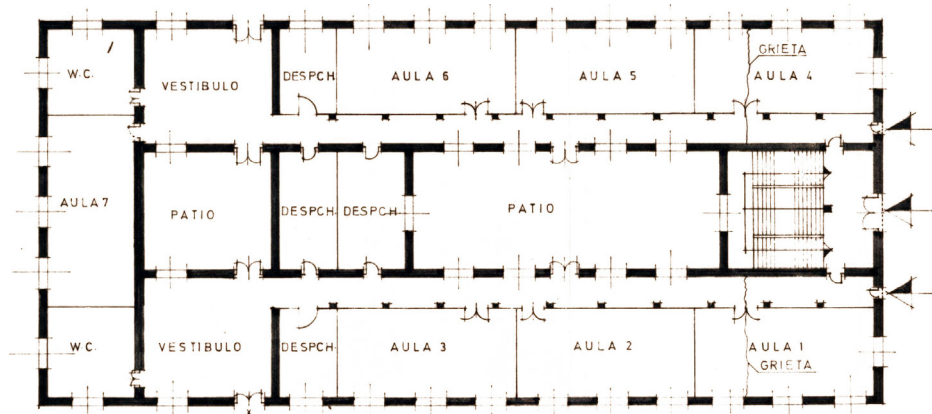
, Planta Baja. Proyecto 1970, Alejandro Vila Ruiz
